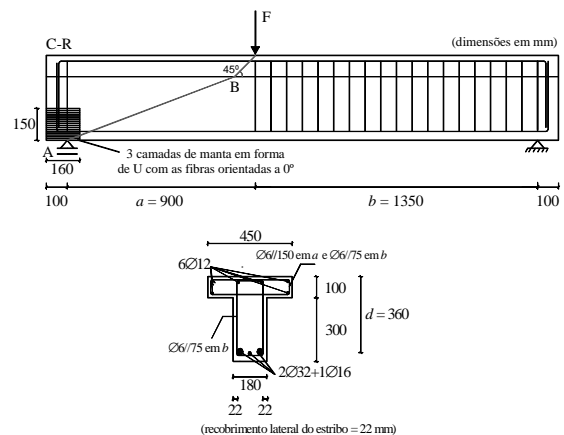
Geometria, tipo de ensaio e armaduras de aço presentes em todos os modelos ensaiados.
